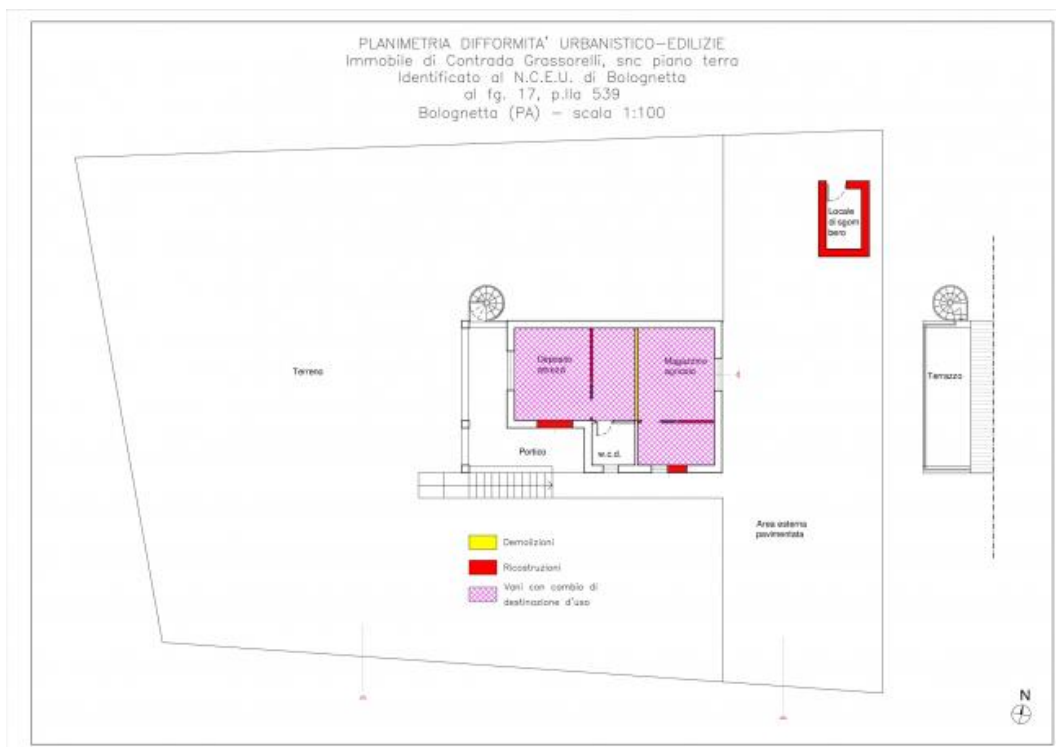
p.lla 539 - Planimetria delle difformità urbanistico - edilizie
